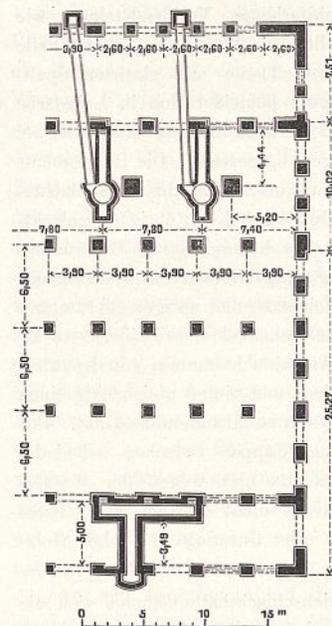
Schlachthalle für Schweine. Luftzuführungs-Canäle in den Fundamenten.
